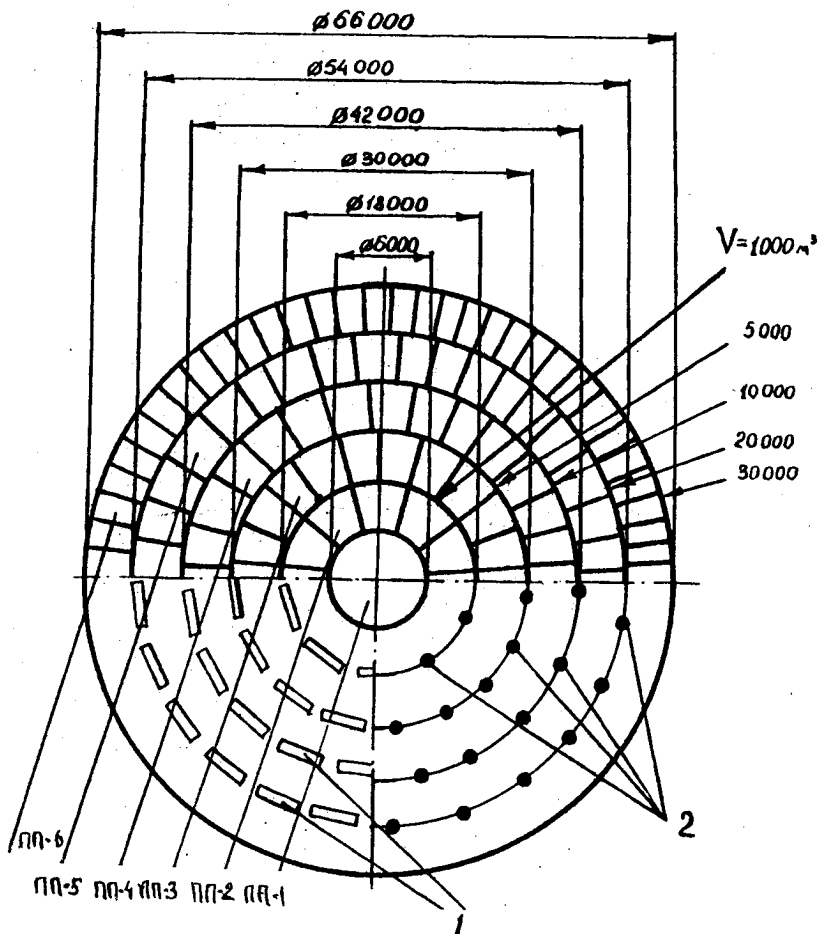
Схема розміщення плит покриття, балок 1 та колон 2 циліндричних залізобетонних резервуарів
